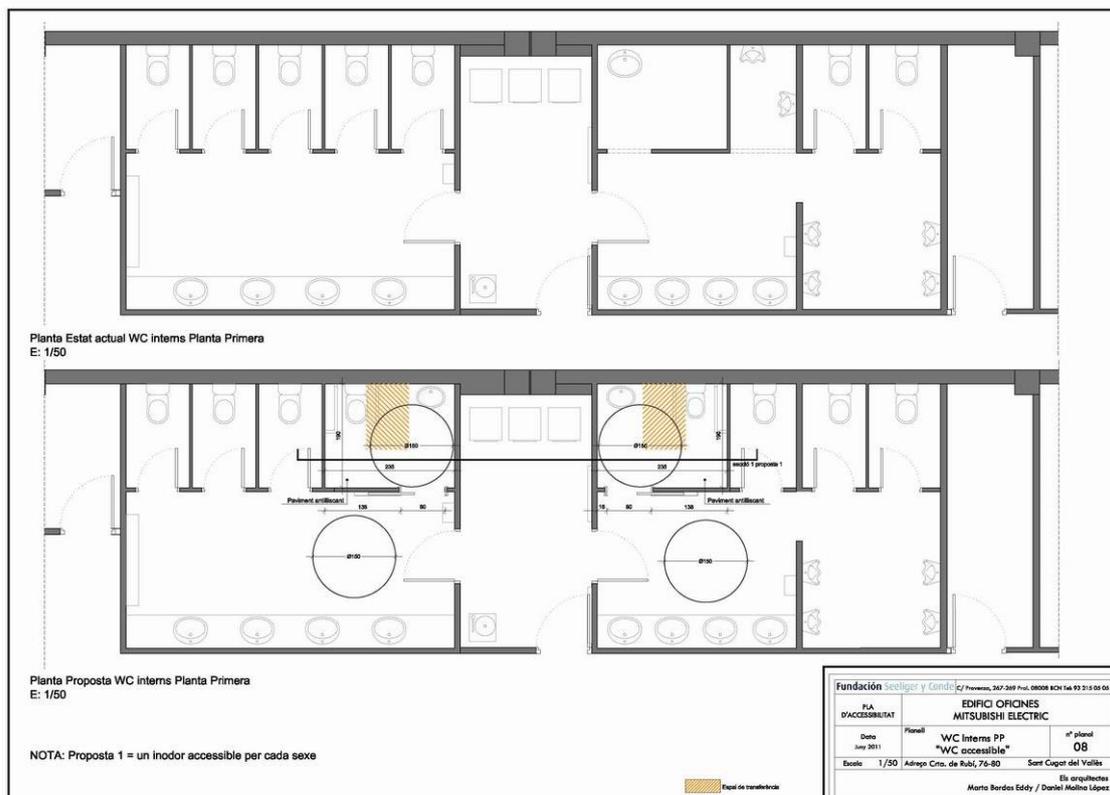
Edificio Oficinas MITSUBISHI ELECTRIC. Planta estado actual y propuesta nueva baños internos 2 de Planta Baja.
